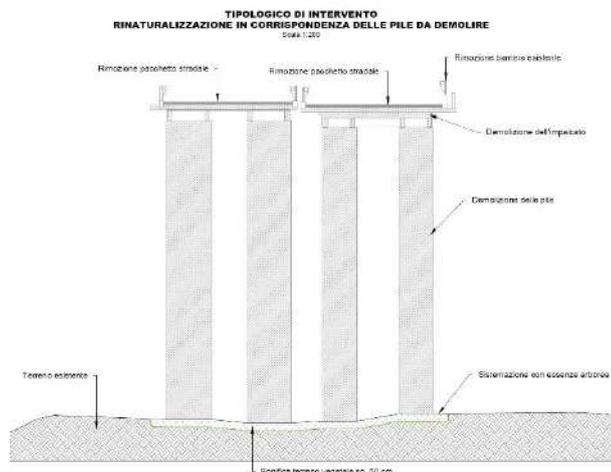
Sezione tipo rinaturalizzazione in corrispondenza delle pile da demolire
